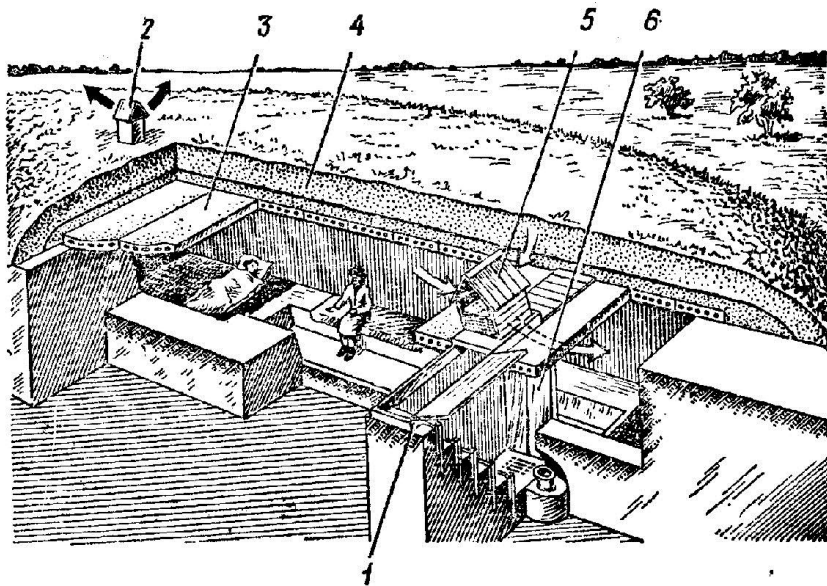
Противорадиационное укрытие с перекрытием из железобетонных плит:
